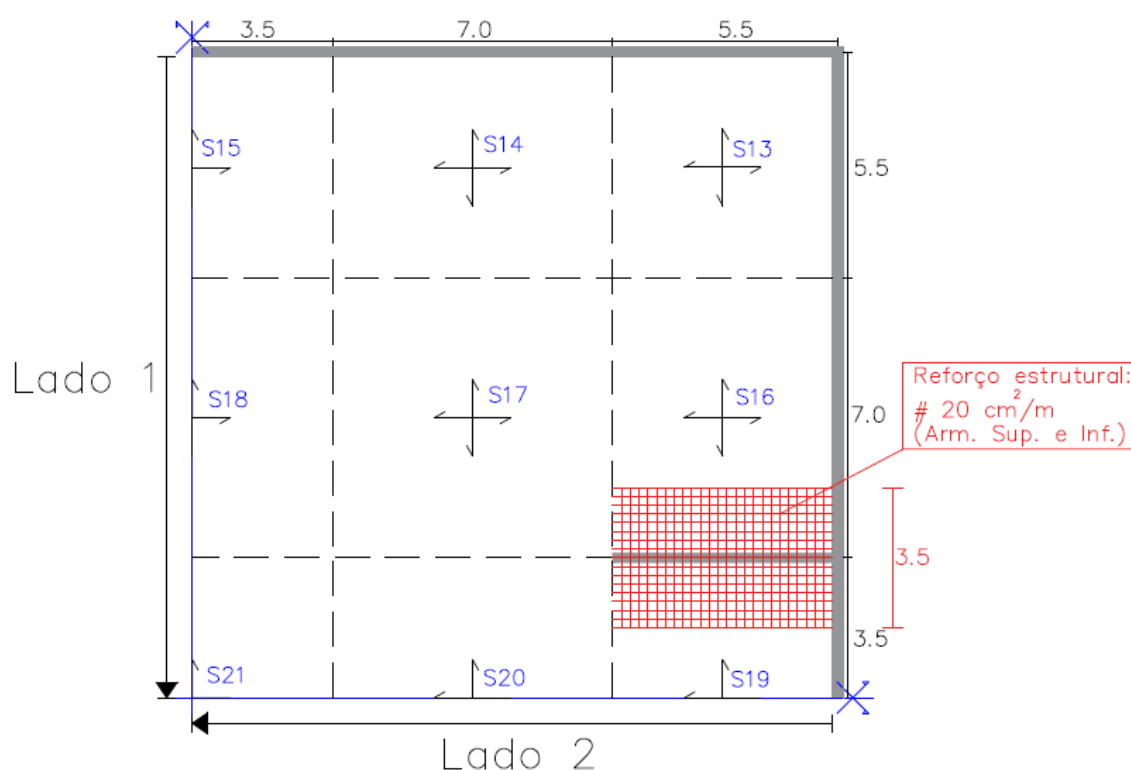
Legendagem dos lados e dos painéis da laje, e indicação da zona com armadura reforçada (dimensões em m).
